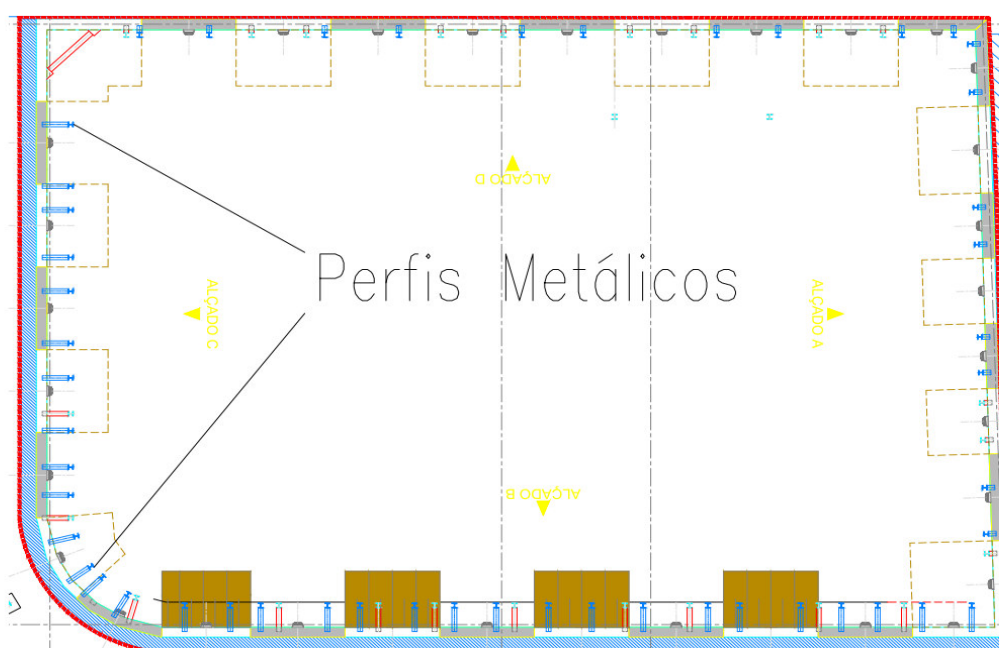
Disposição em planta da localização dos perfis metálicos.
